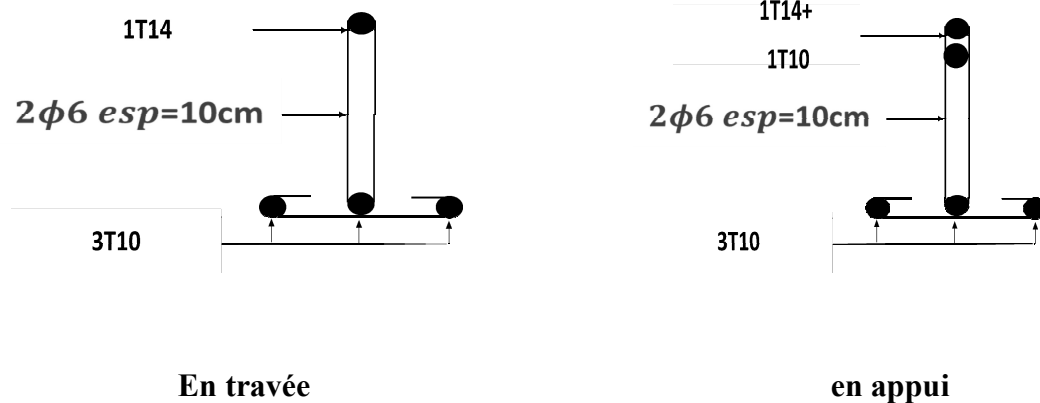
ferrailage des poutrelles en Travée et en Appuis
